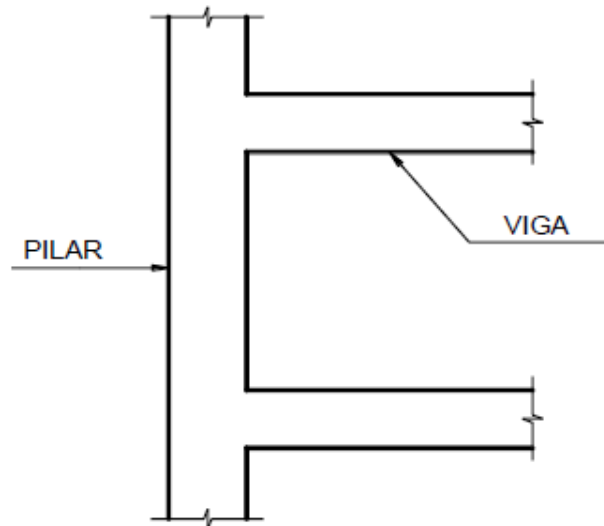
Vigas de concreto apoiadas sobre pilares. Fonte: Bastos (2019).
